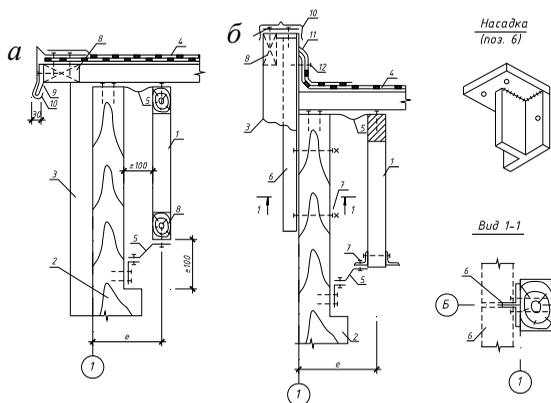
Детали связи фахверковых колонн со стропильными конструкциями:
